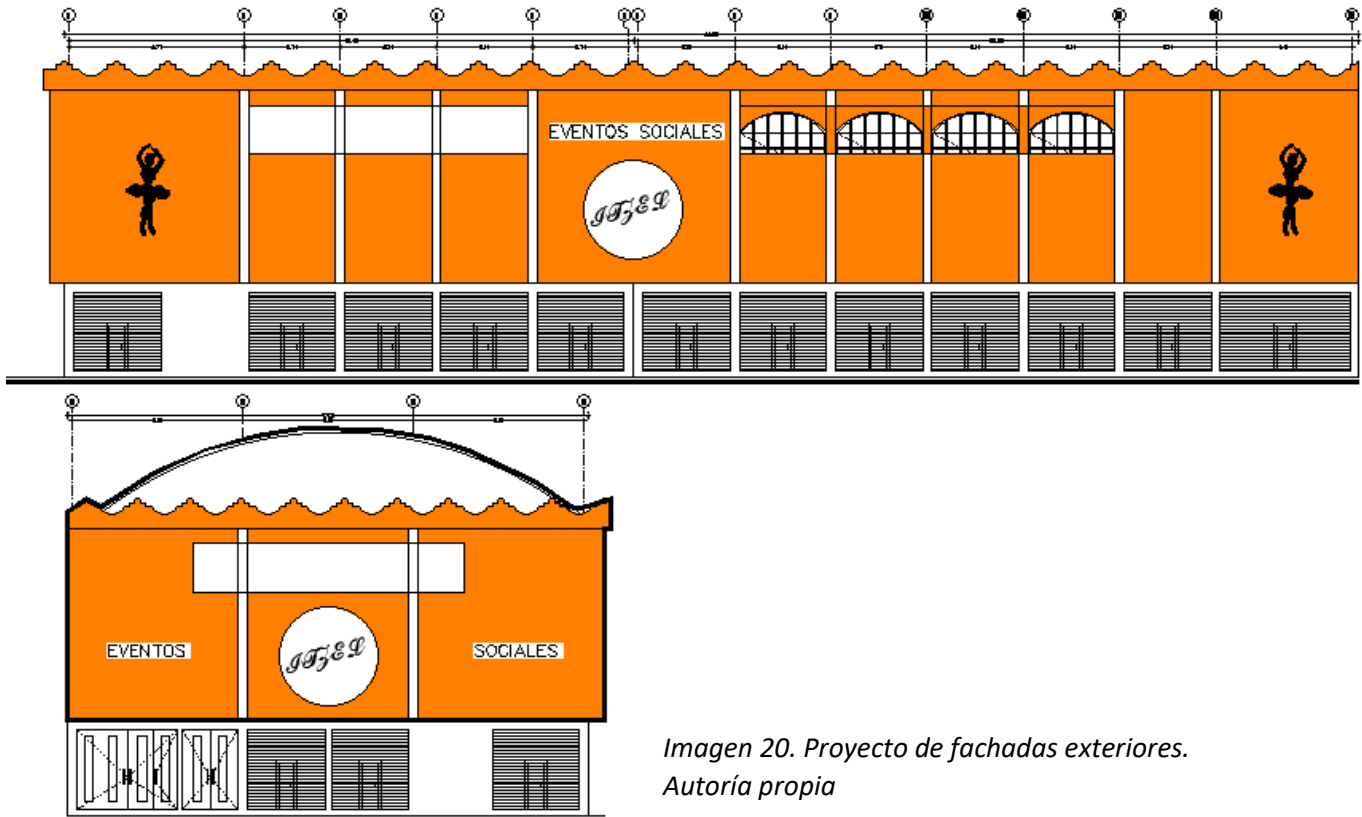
Proyecto de fachadas exteriores. Autoría propia
